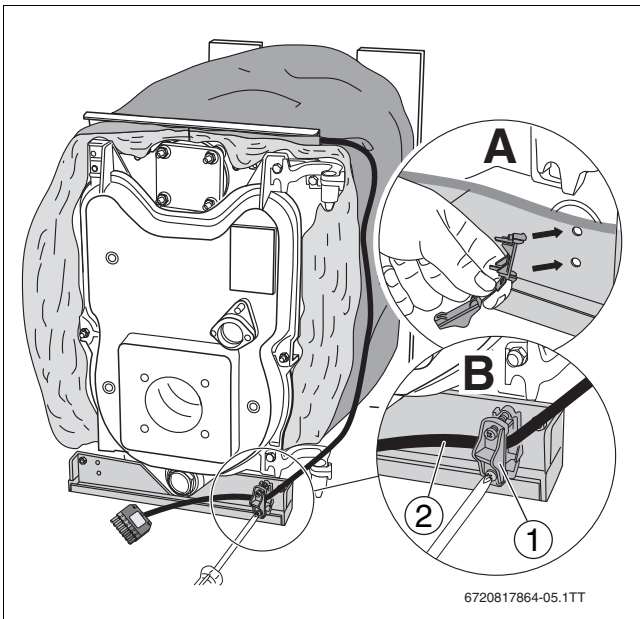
Montaje del dispositivo antitracción y del cable del quemador
